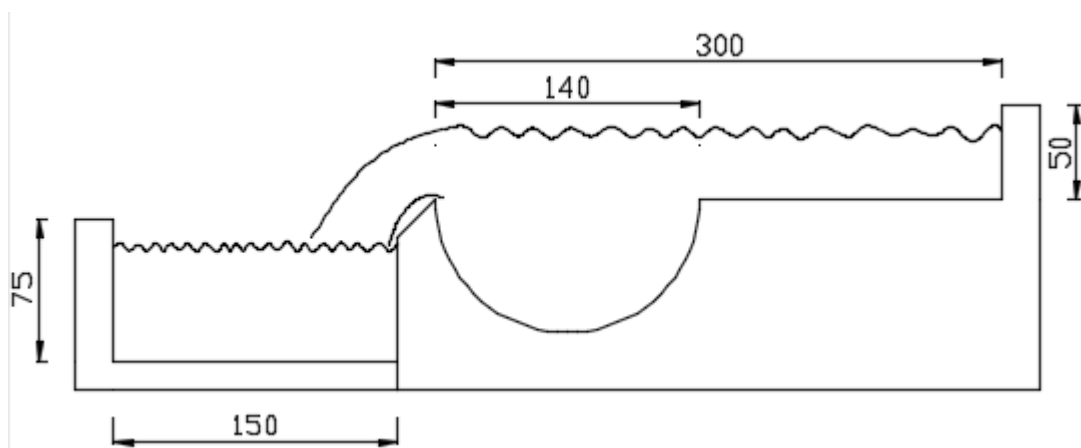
Canal de entrada con aliviadero lateral y canal "by-pass" (Cotas mm.)
